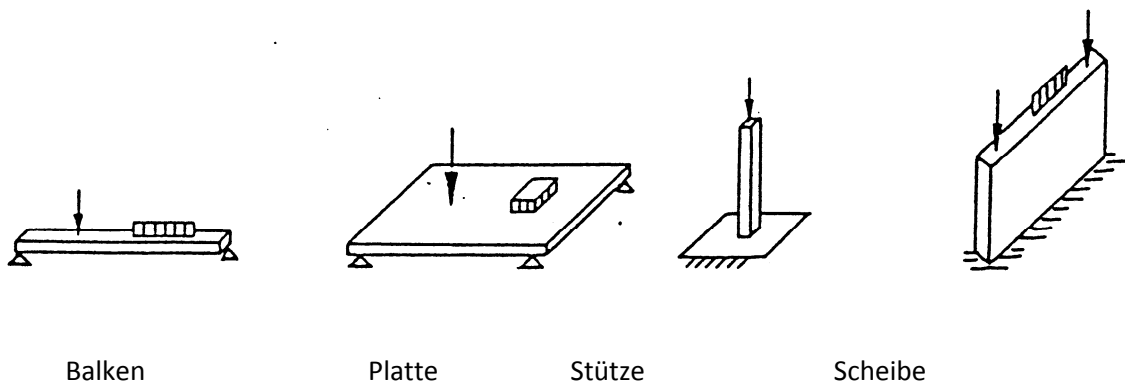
Die vier Bauelemente des Stahlbetonbaus
